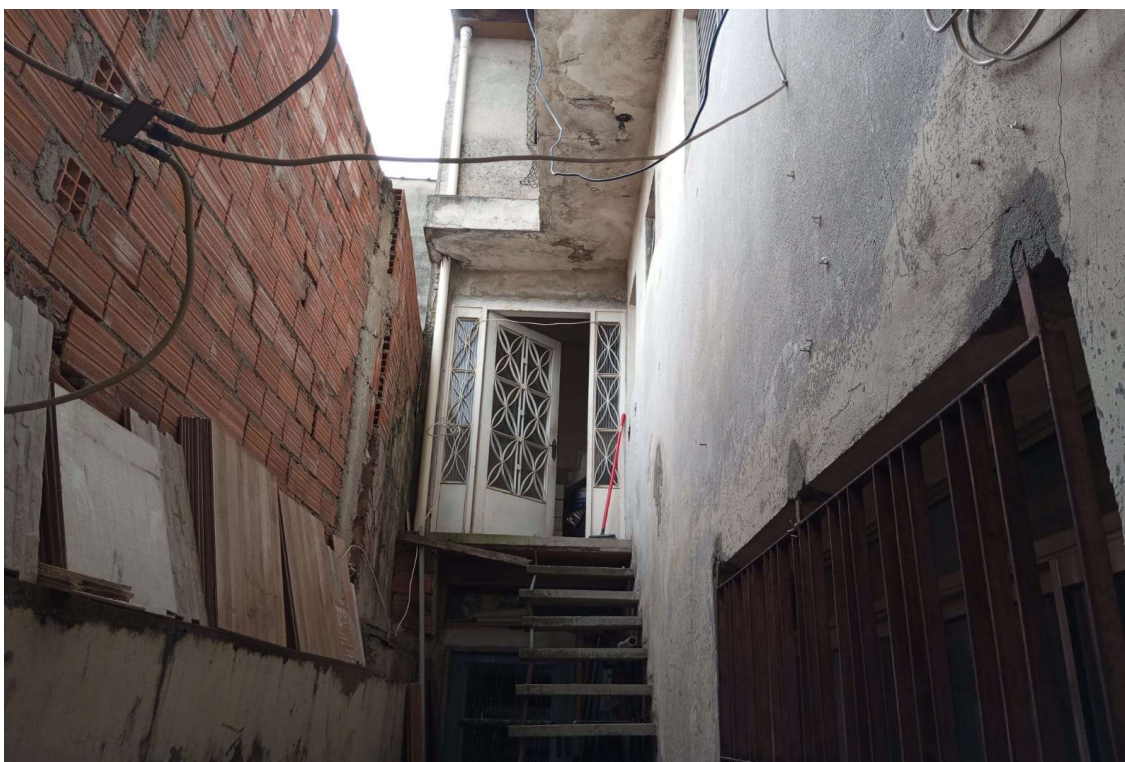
Vista da escada de acesso aos pavimentos.
